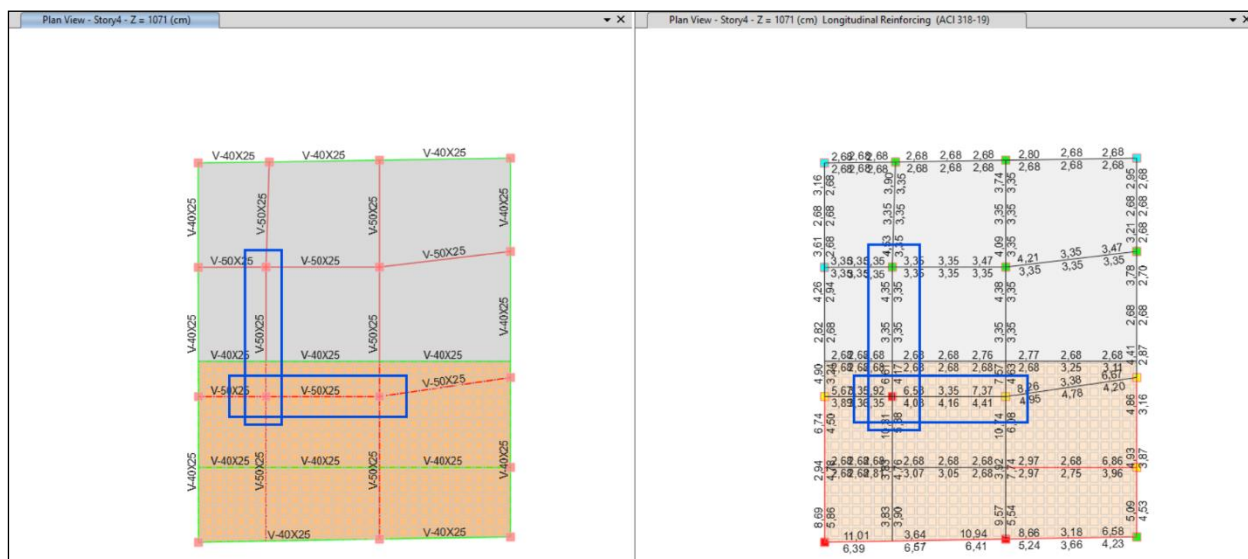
Acero a flexion en vigas de losa nivel 4, alternativa 2 [Autor]
